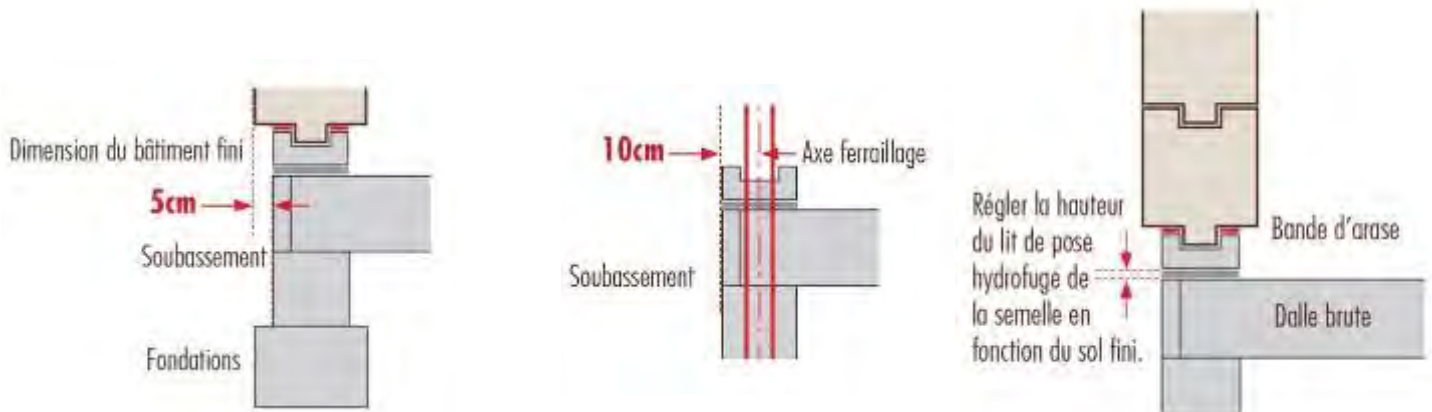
Implantation du soubassement, du ferrailage et de la semelle de départ
